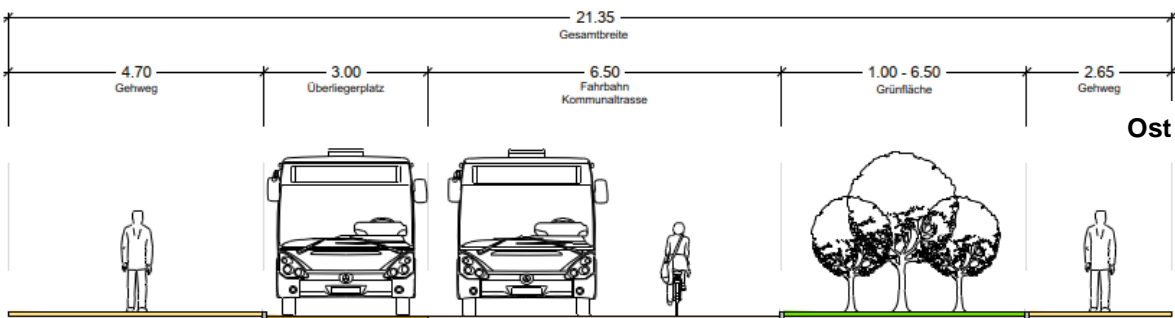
Geplanter Querschnitt Große Bahnstraße
